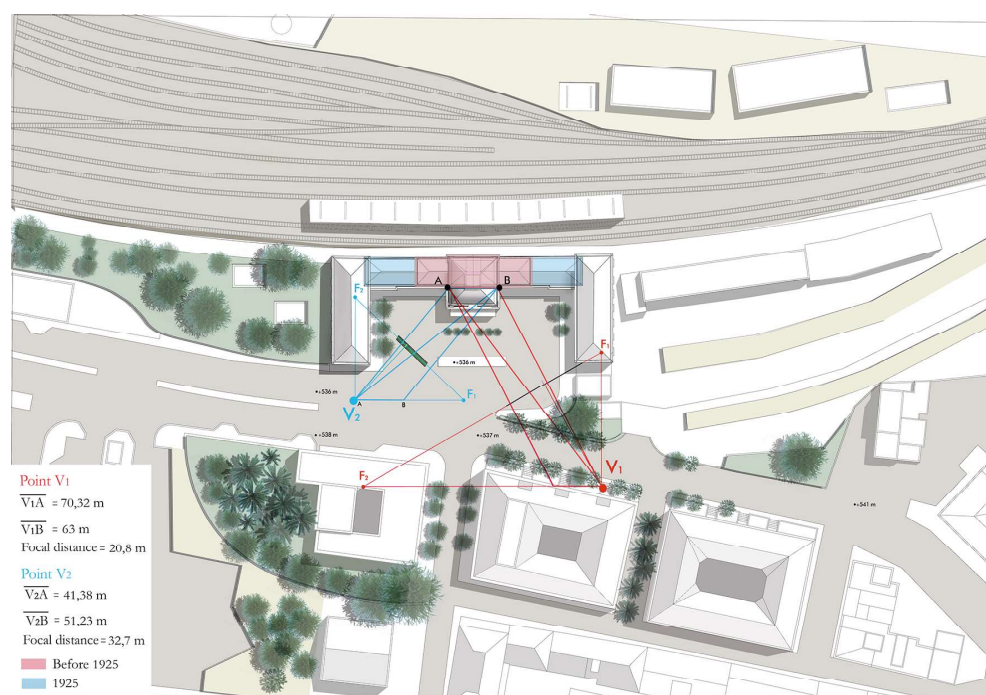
Planimetria della stazione di Caltanissetta Centrale e punti di presa delle foto d'epoca. Archivio autori.
